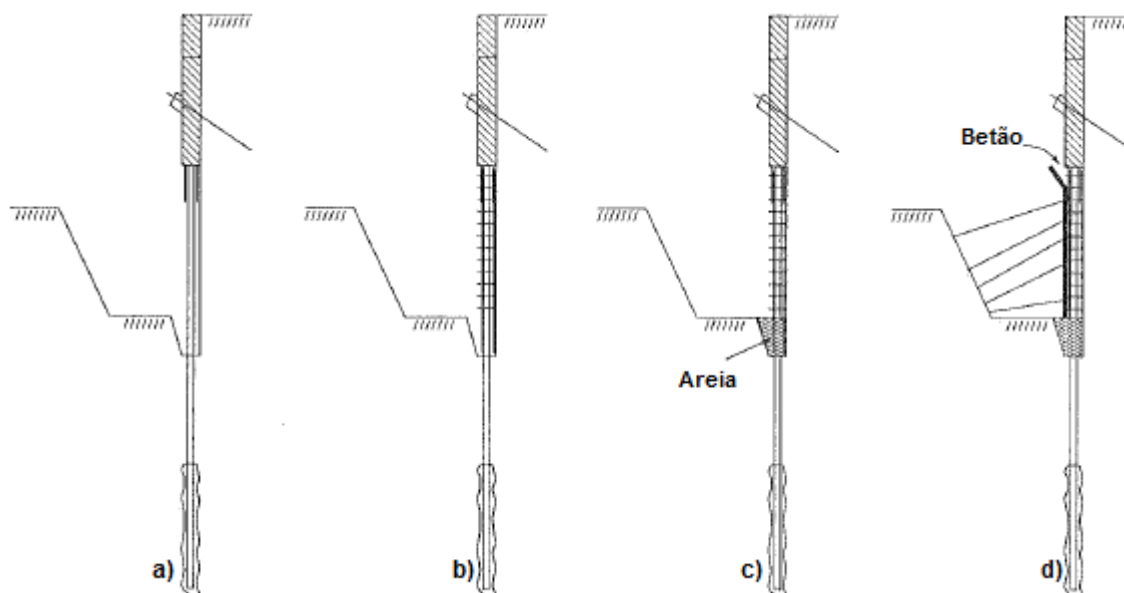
Detalhe das fases de execução da parede compreendidas entre a escavação dos painéis e a realização da sua cofragem para posterior betonagem [37]
